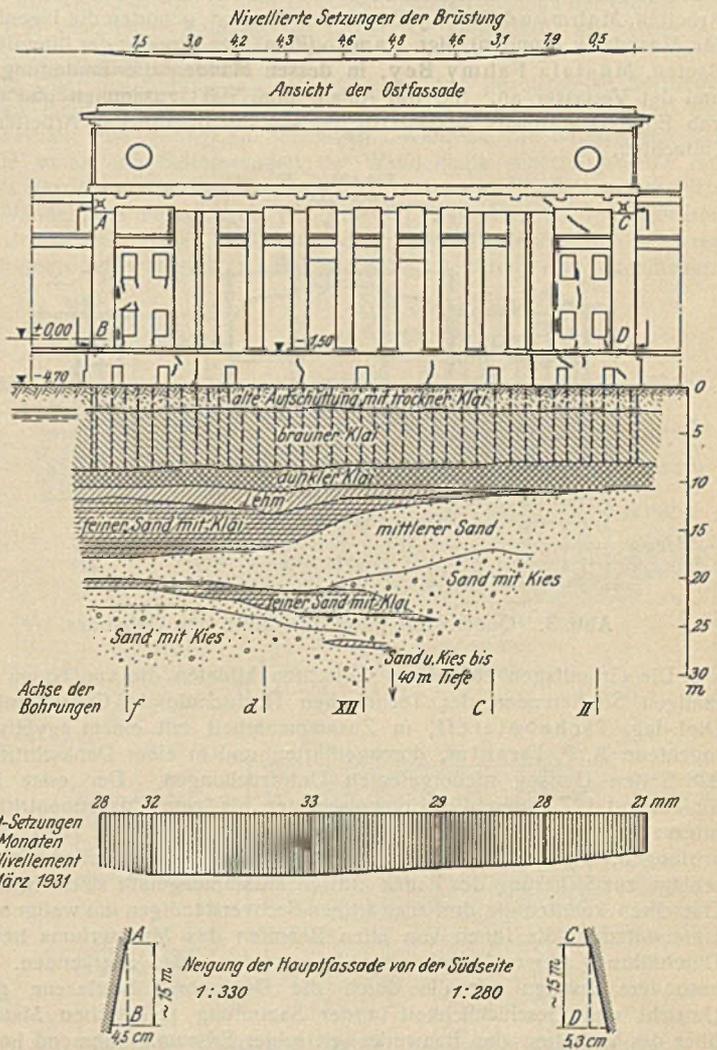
Ostfassade, Bodenbeschaffenheit, Setzungen.
